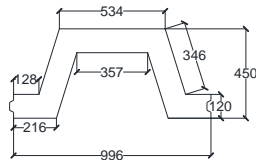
Detail sheet pile W-600 kelas B, L = 21 m
